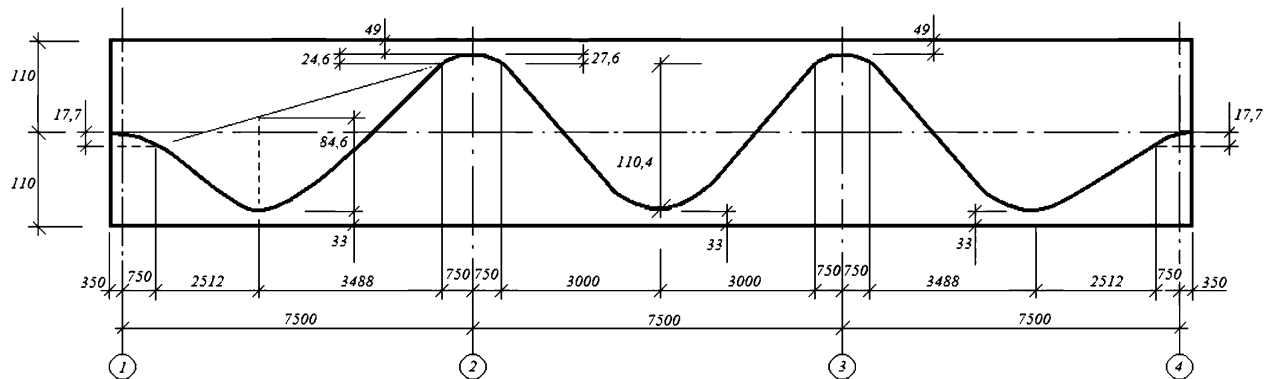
Конфигурация криволинейного очертания раскладки арматурных элементов по высоте сечения и длине плиты перекрытия (в направлении буквенных осей)
